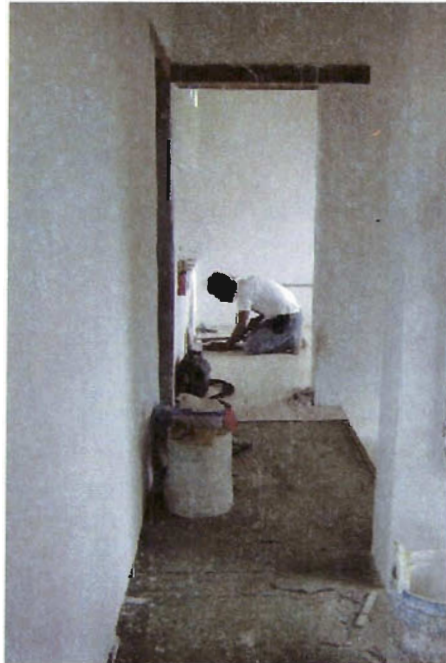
Proceso de colocación de piso cerámico sobre losa en entrepiso
